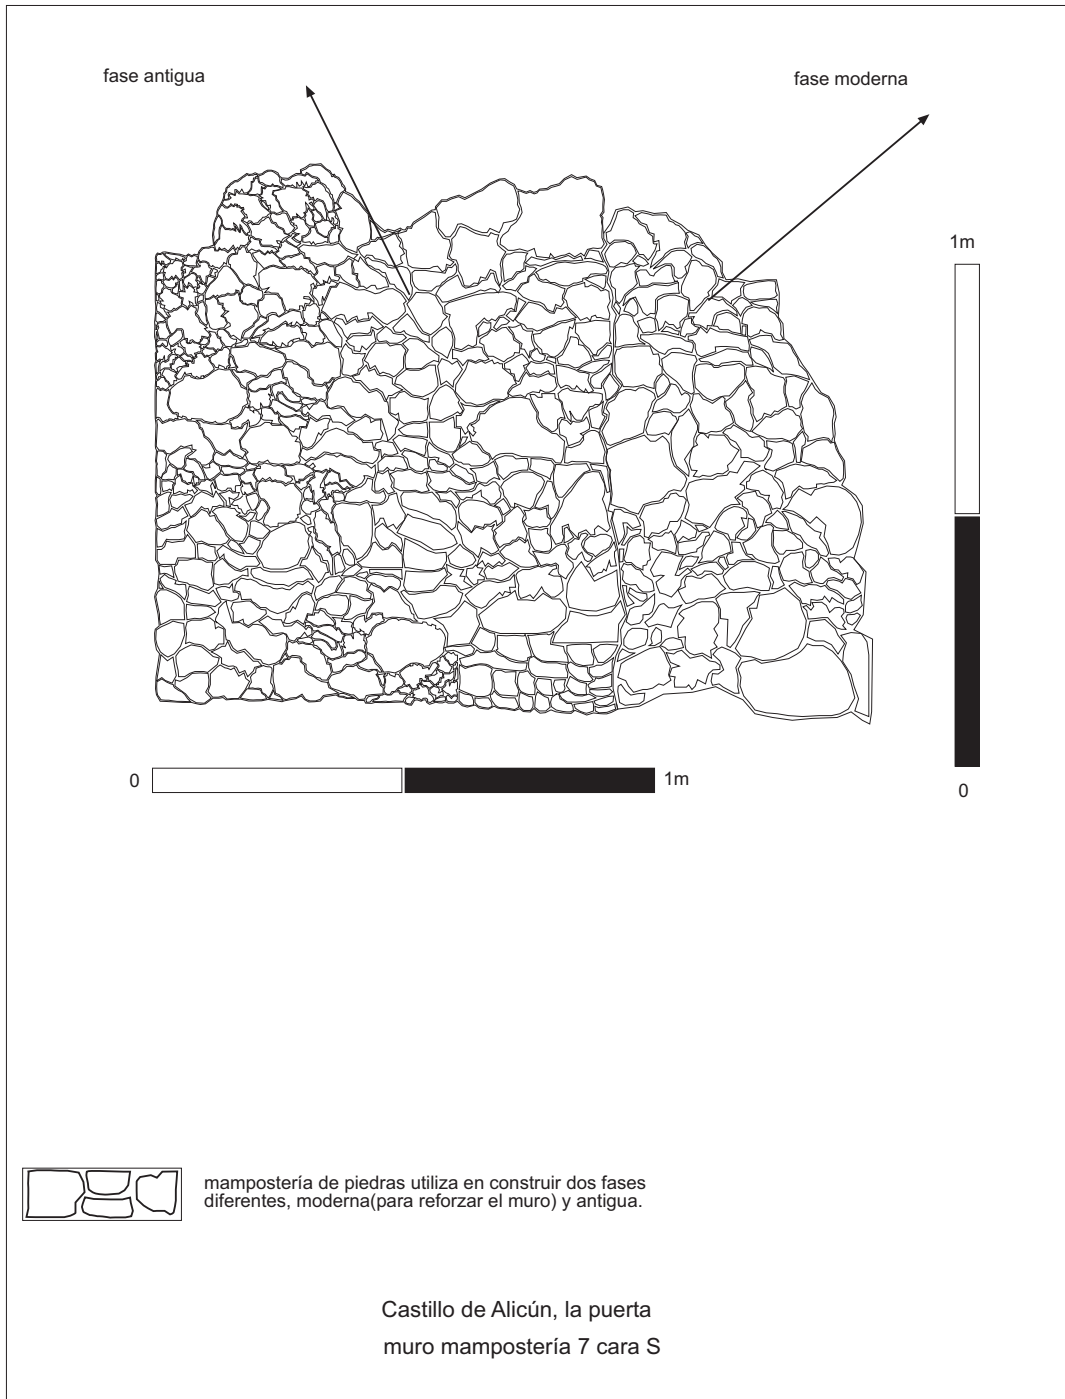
Castillo de Alicún, muro mampostería 7 de la puerta en su cara S. La técnica constructiva, Mampostería concertada.
